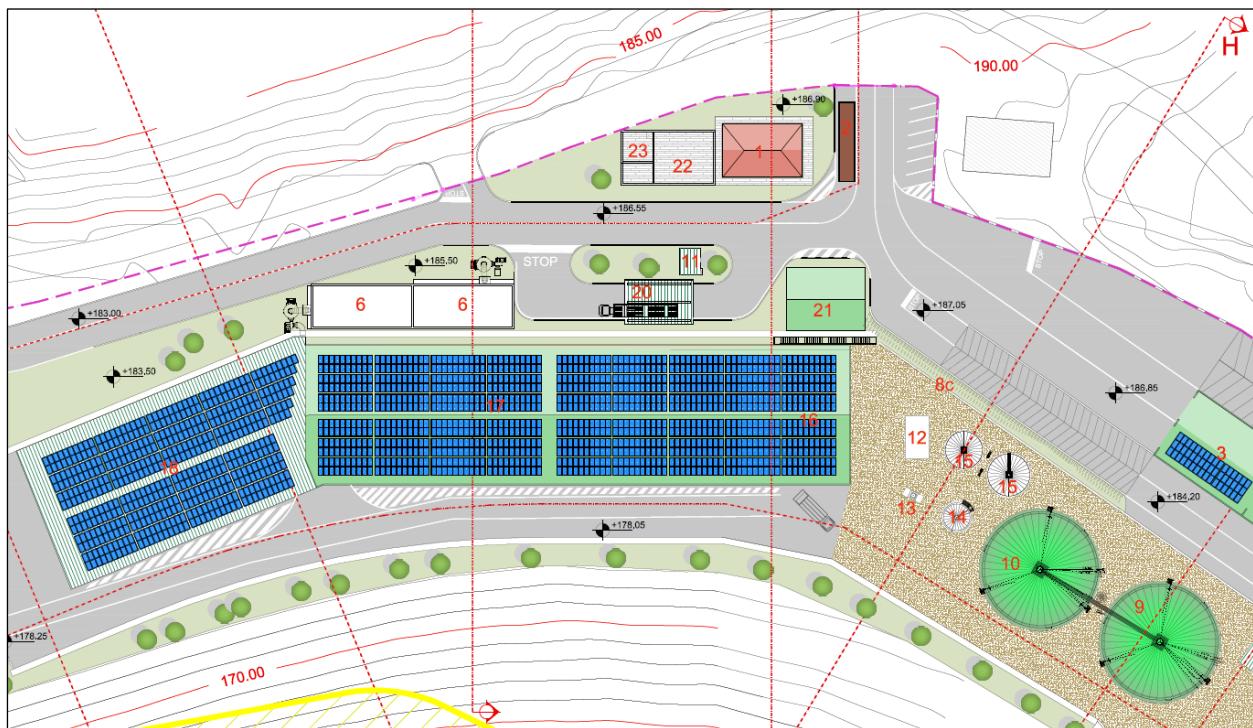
Vista del sito dell'impianto e degli accessi previsti nel progetto definitivo approvato
